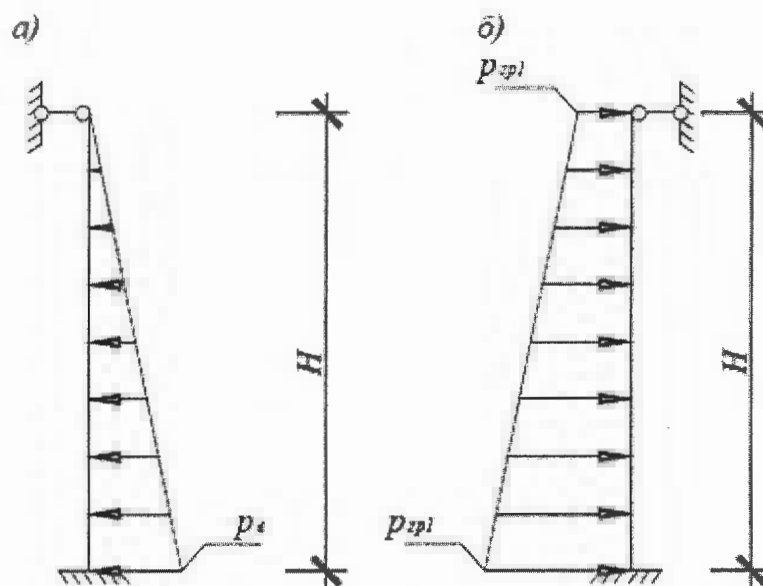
Схема нагружения стен бассейна: а – от воды, б – от грунта
